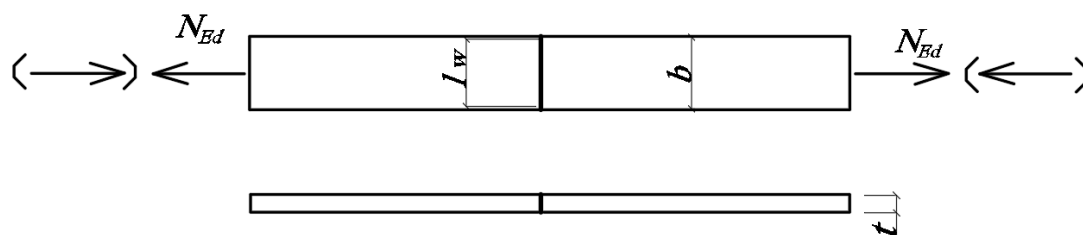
Прямой стыковой сварной шов
